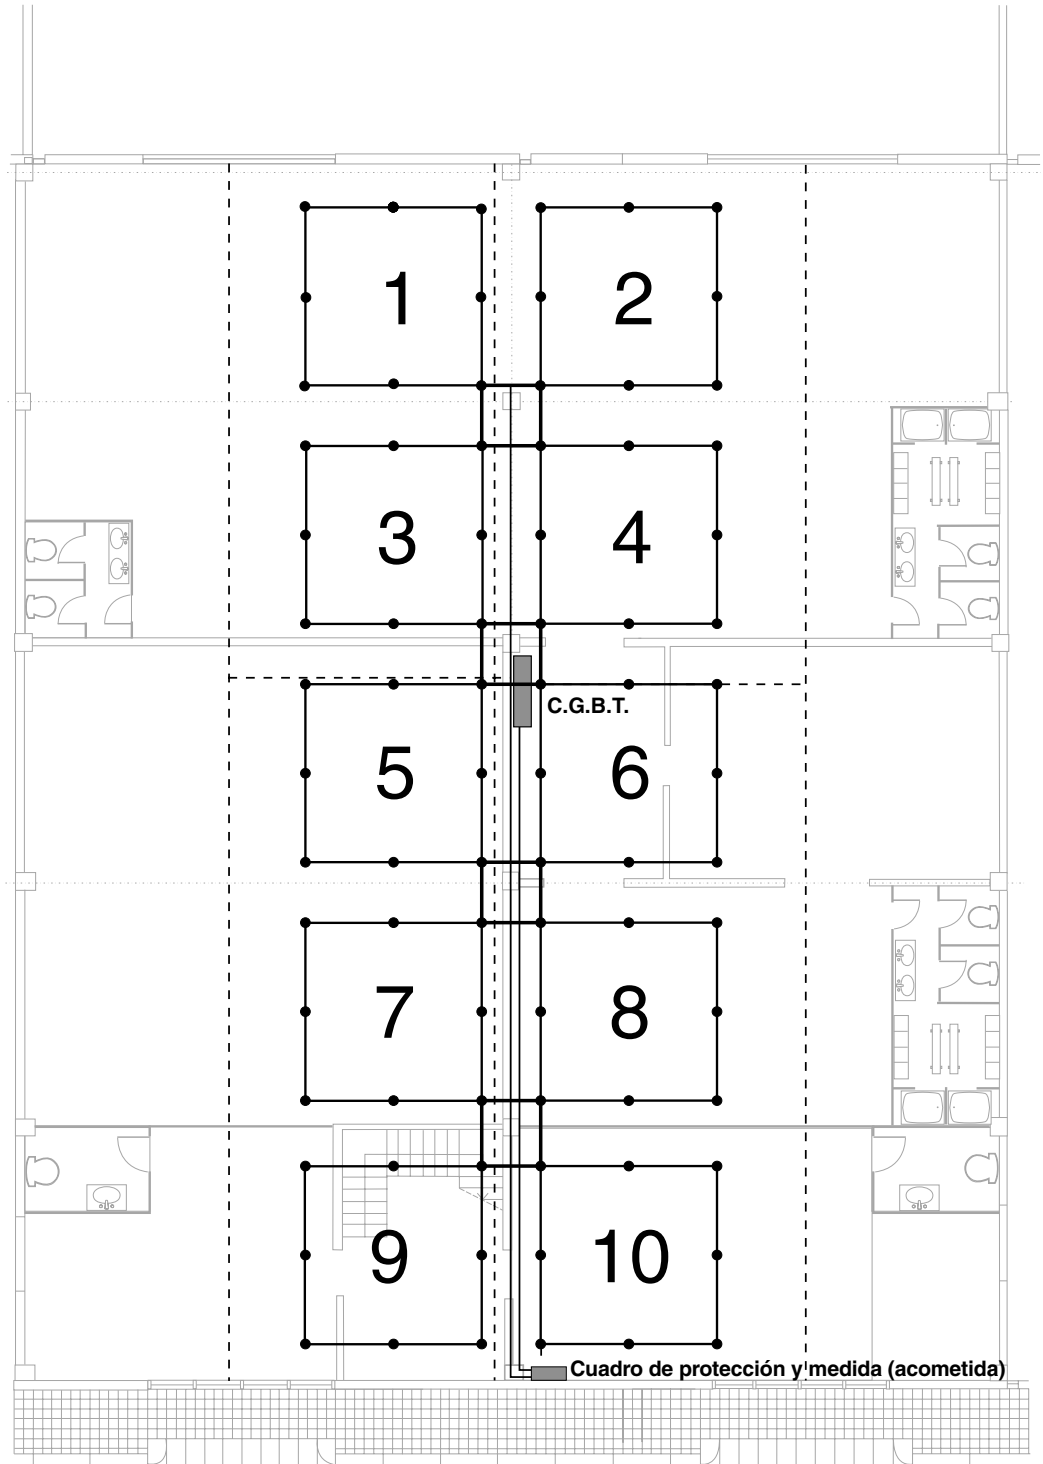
situación en planta de la toma de tierra del edificio.
